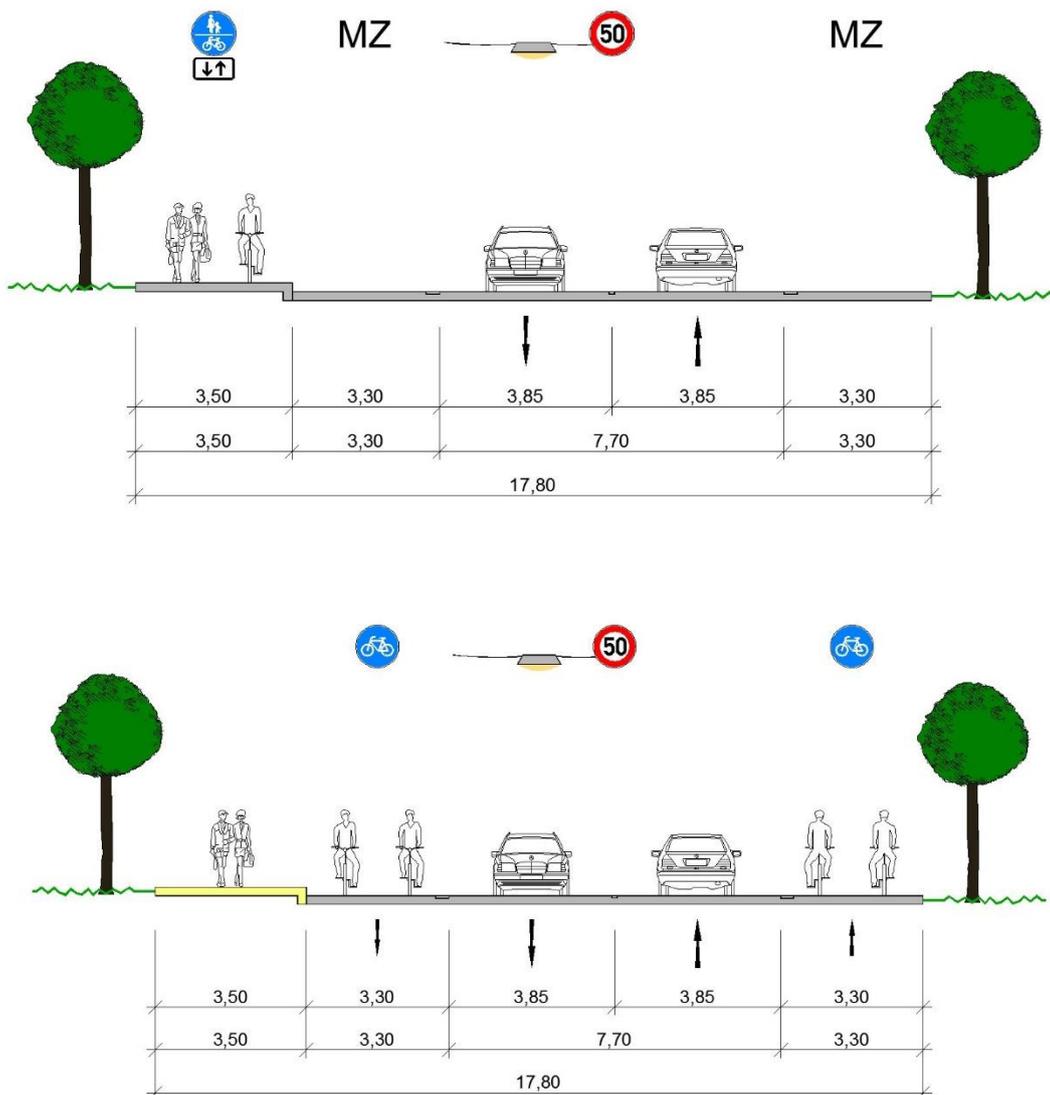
Bottroper Str. (Hornstraße – Stadtgrenze) – Bestand (oben) und Planung (unten)
